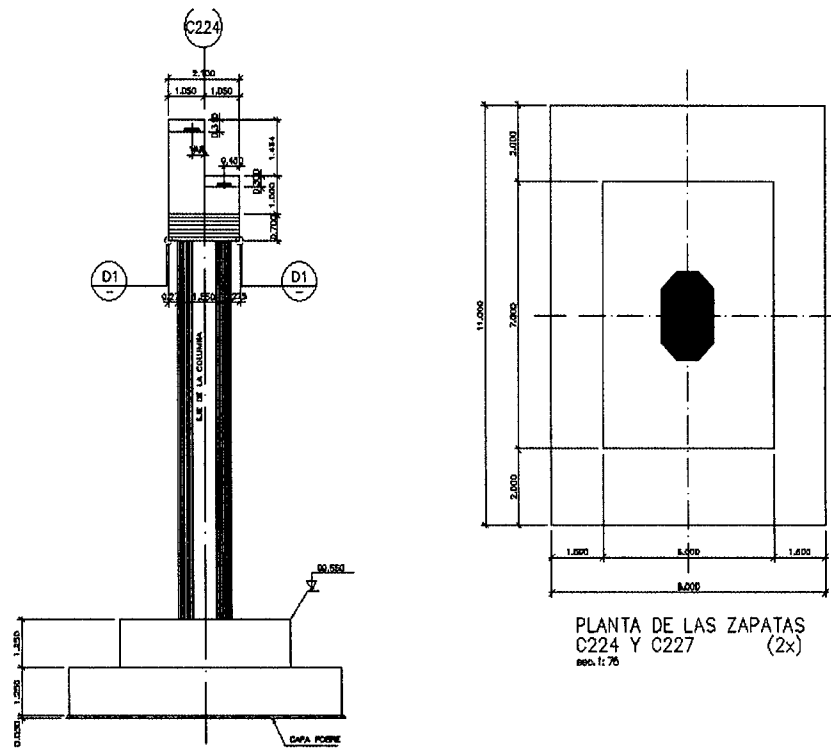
Elevación longitudinal de las columnas y planta de las zapatas (C224 y C227)
